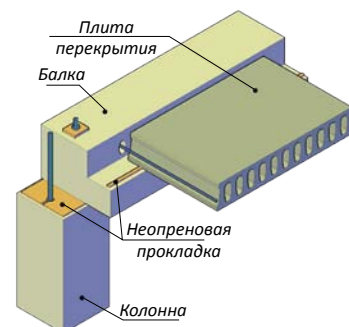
Соединение балки типа RL с колонной и многупустотной плитой перекрытия
